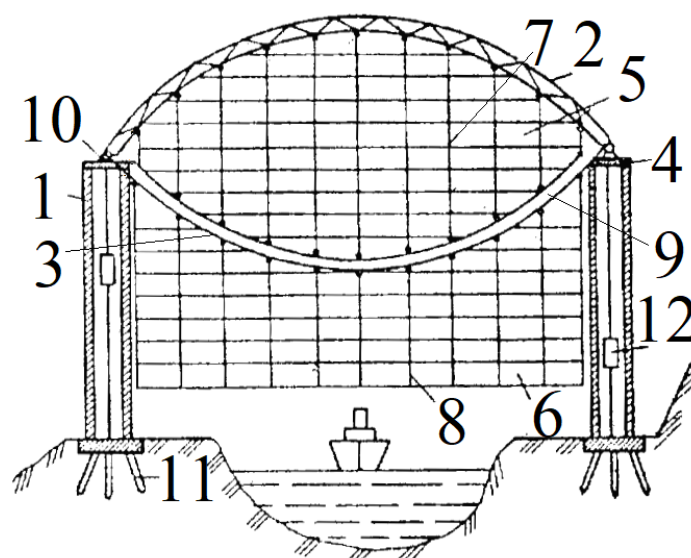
Большепролётное многоэтажное сейсмостойкое здание: 1 – несущие стволы; 2 – арочные фермы; 3 – ванты; 4 – оголовки; 5,6 – конструкции этажей; 7, 8 – подвески; 9 – зазор; 10 – узлы крепления ферм и вант; 11 – фундаменты; 12 – лифты
